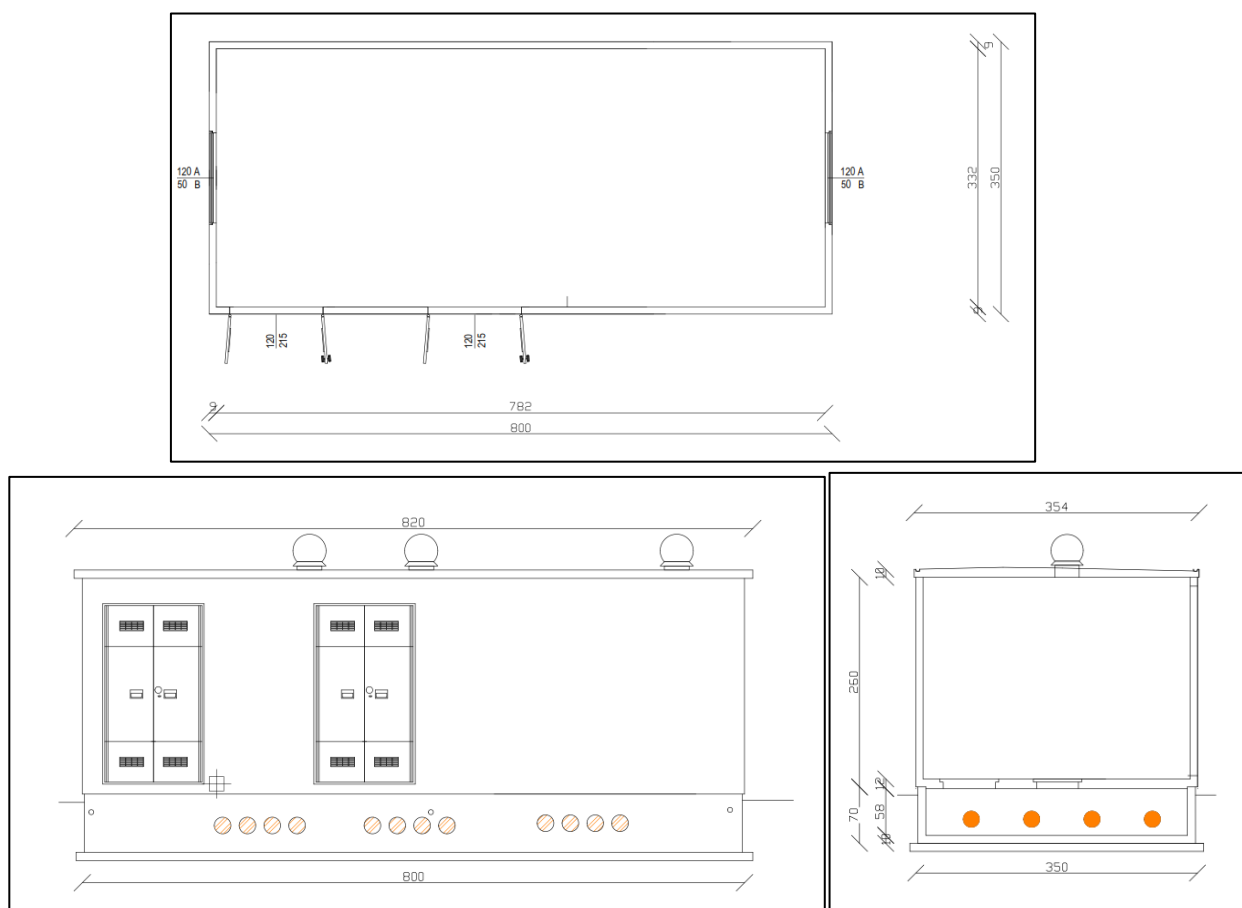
Vista in pianta/prospetto/sezione cabina utente.
